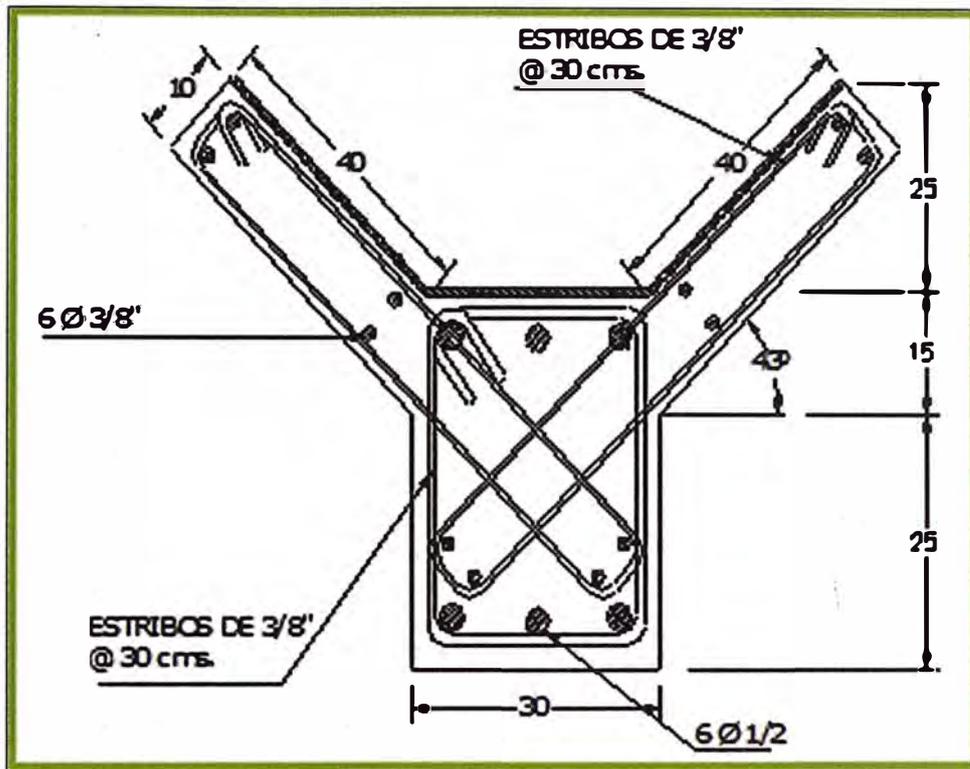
Viga canal de concreto central o doble (Referencia 3)
